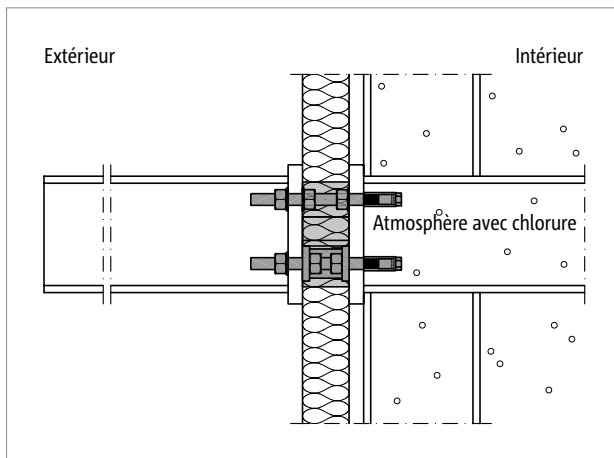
Schöck Isokorb® T type S avec écrou borgne : construction en acier en porte-à-faux libre; atmosphère intérieure avec chlorure
